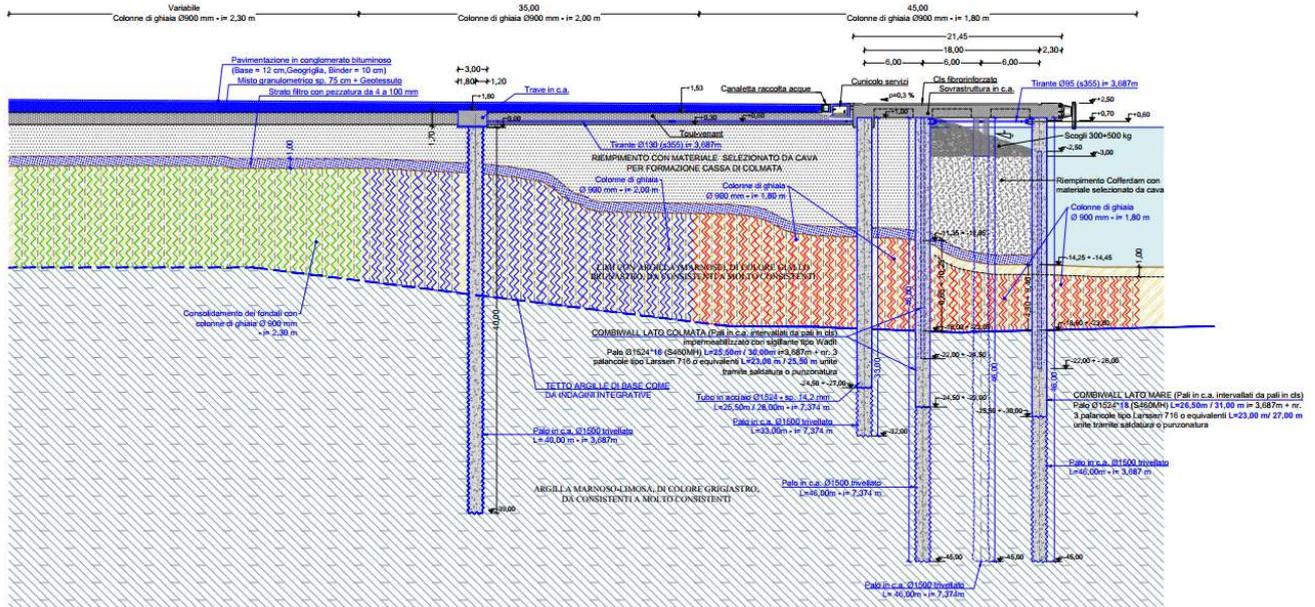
Banchina Operativa Sud – Sezione “Tipo 3”
